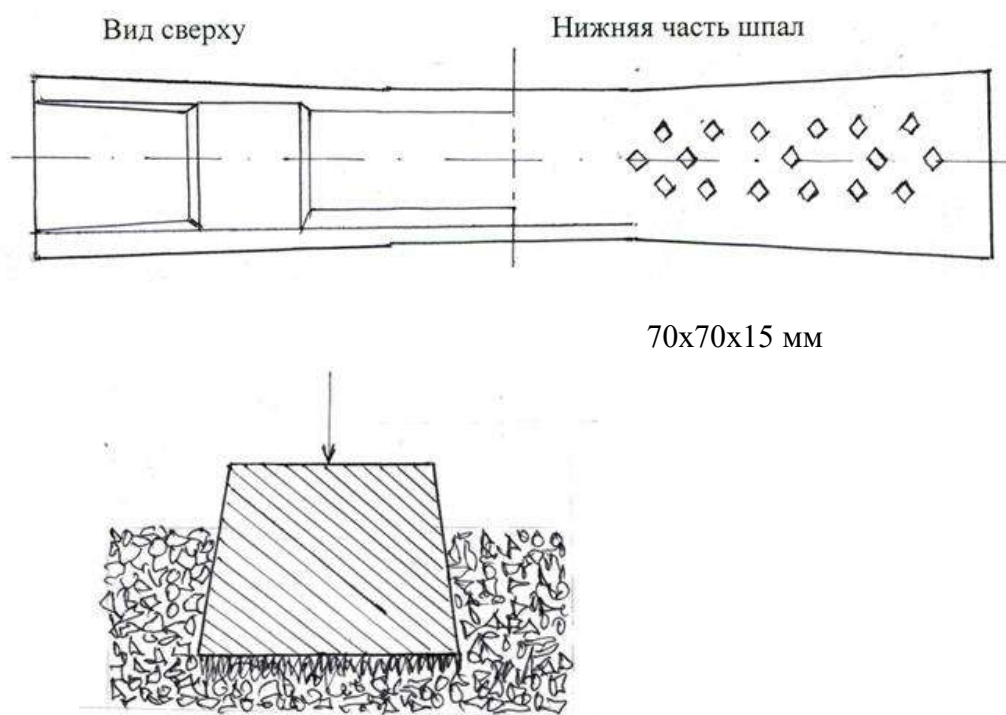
«Зубатые» и специально углубленными железобетонные шпалы
